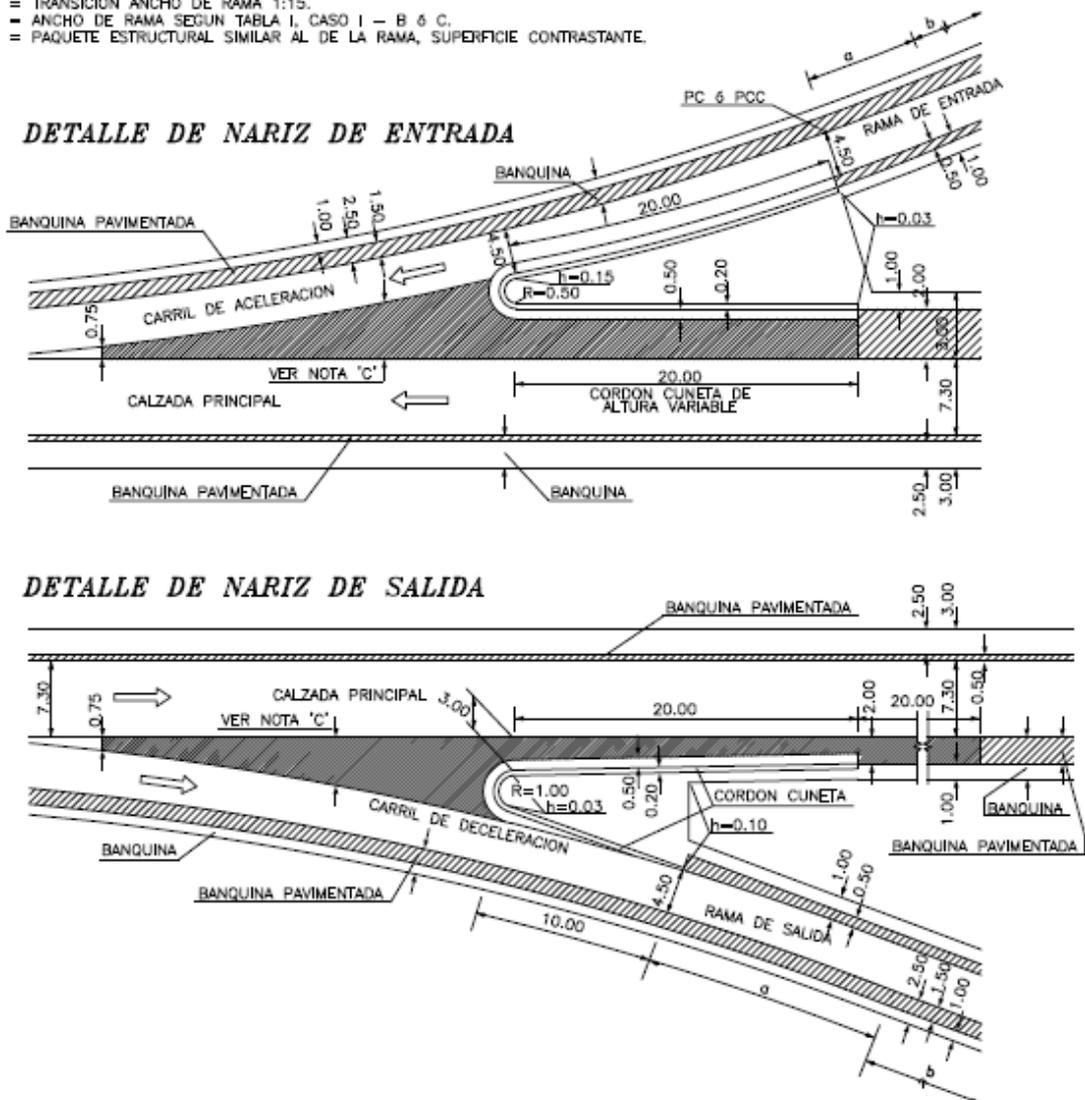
Detalle de narices según Plano Tipo OB2 de la DNV
